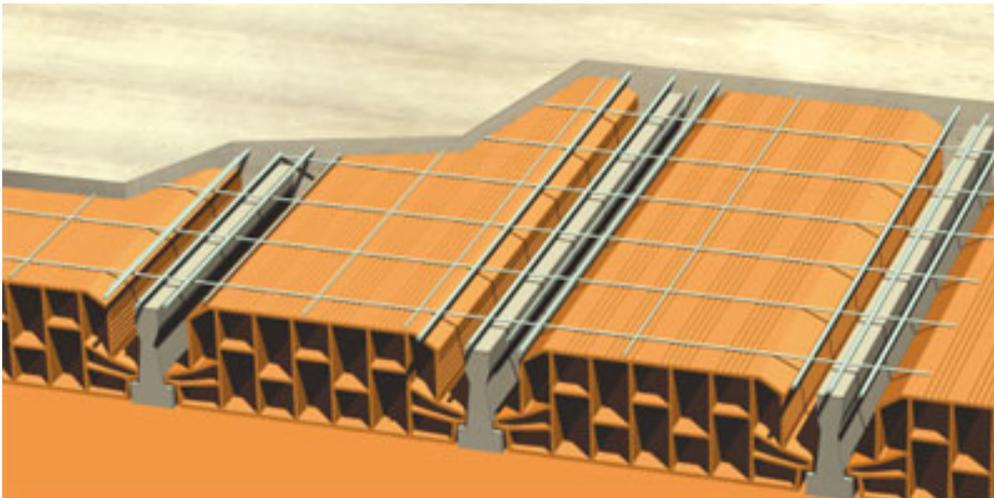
Forjado unidireccional con viguetas pretensadas (fuente: Construmatica).
